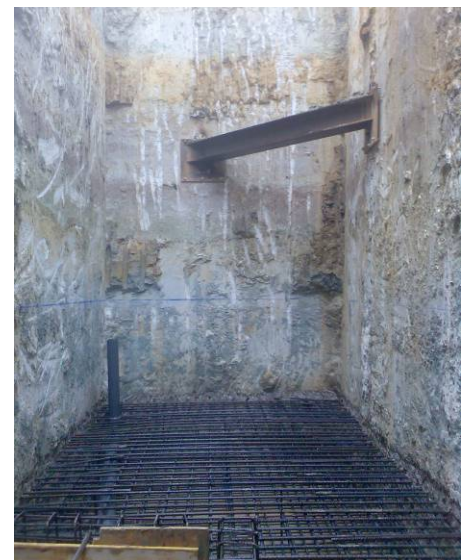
Chumbadouro embebido na laje para apoio do escoramento
